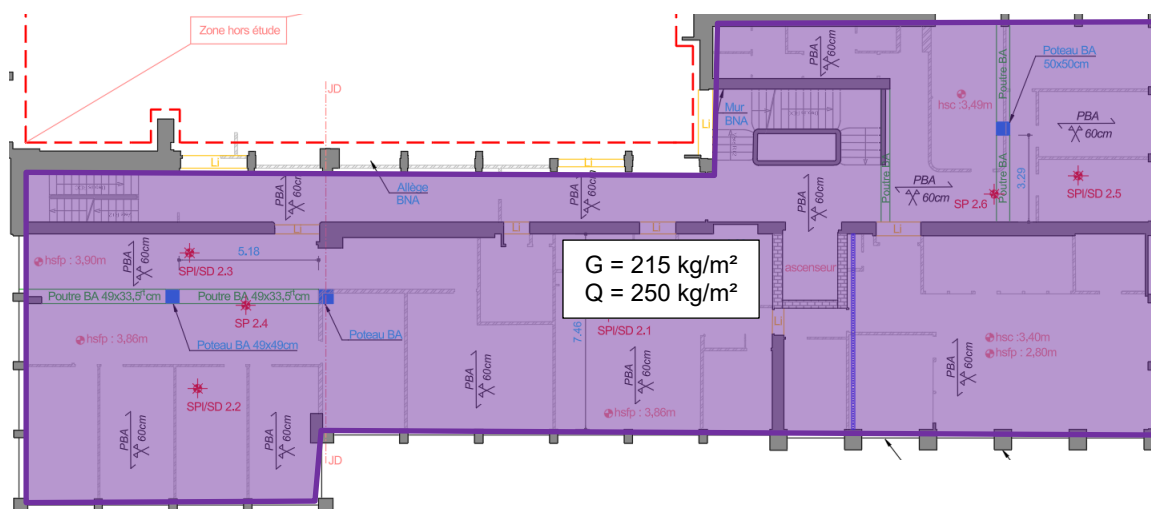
Charges considérées PH R+1 (hors poids propre béton armé)
